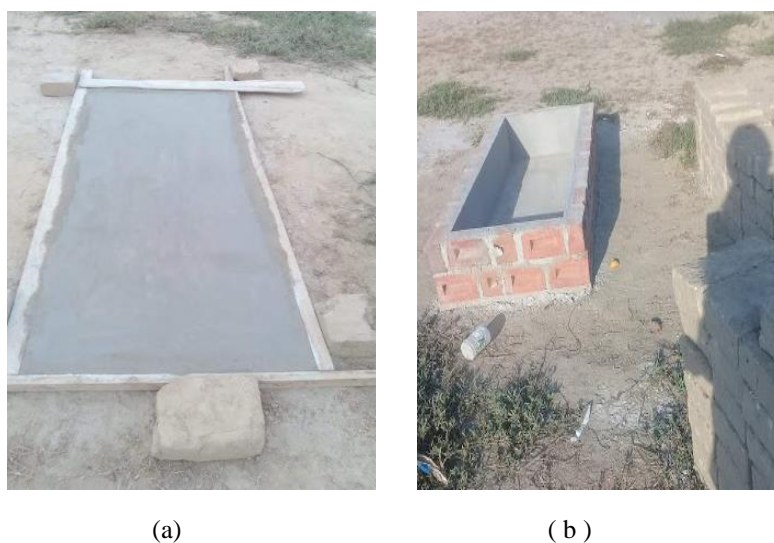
Construcción del Canal de Ensayo.(a)Losa de canal de ensayo.
